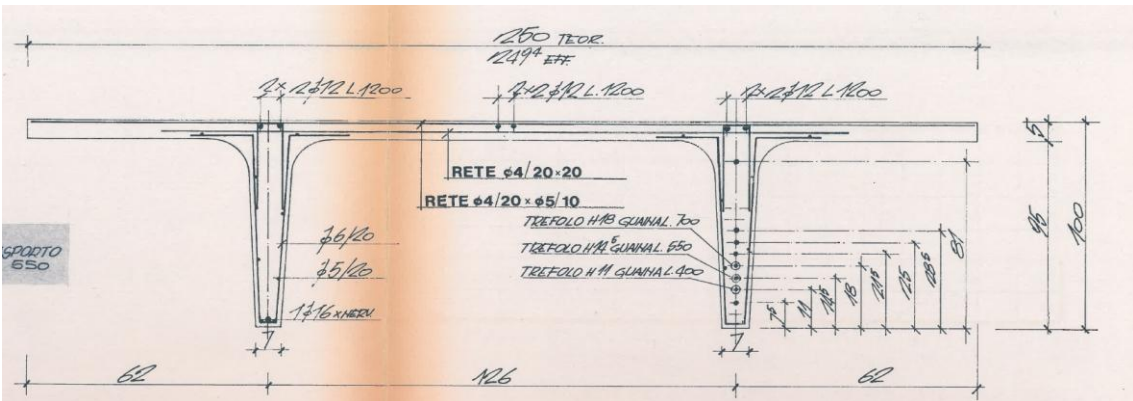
Particolare di A.1990.cap.us.T17 - Armatura tegolo h 100-7 - Sezione trasversale
